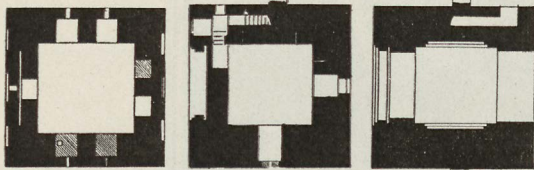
Riesenburg. Thorthurm, Grundrisse der drei unteren Geschosse. 1 : 400.
